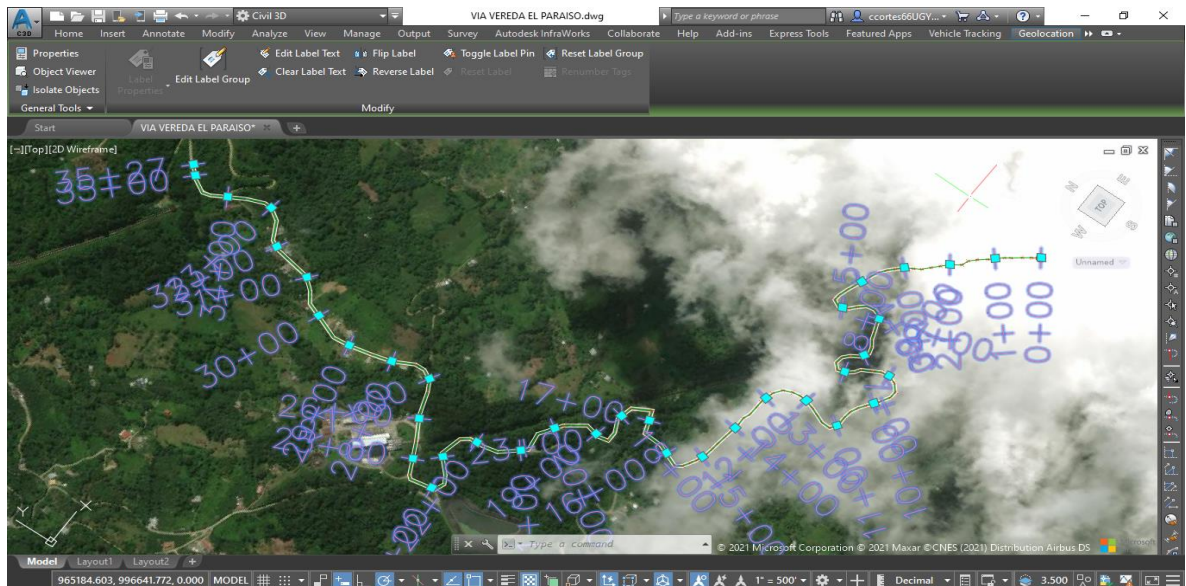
Trazado vía - AutoCAD Civil 3D
